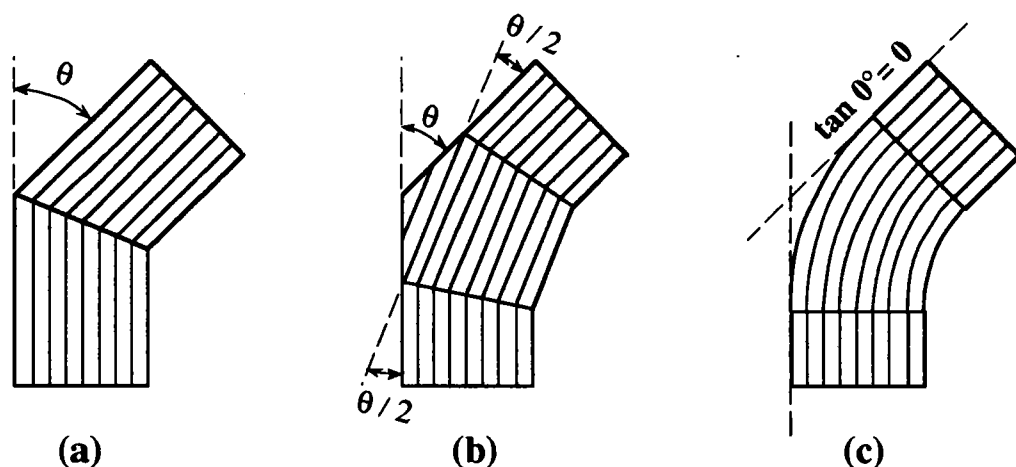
Assemblages d'angle de bois sur bois. a) aboutage directe d'une pièce sur l'autre. b) assemblage par pièce de coin. c) assemblage par pièce courbe.
